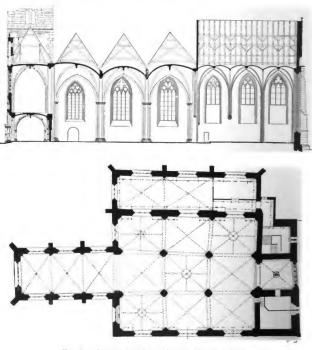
Grundrifs und Längsschnitt der Liebfranenkirche.
